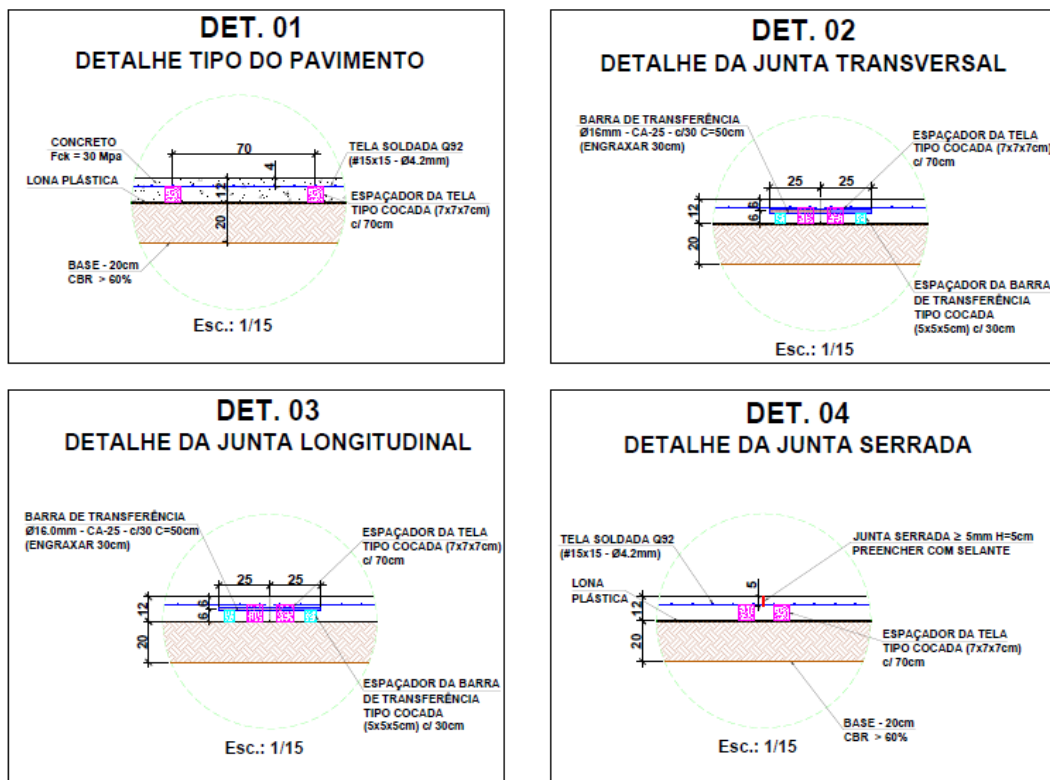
DETALHE DAS JUNTAS DO PAVIMENTO RÍGIDO
